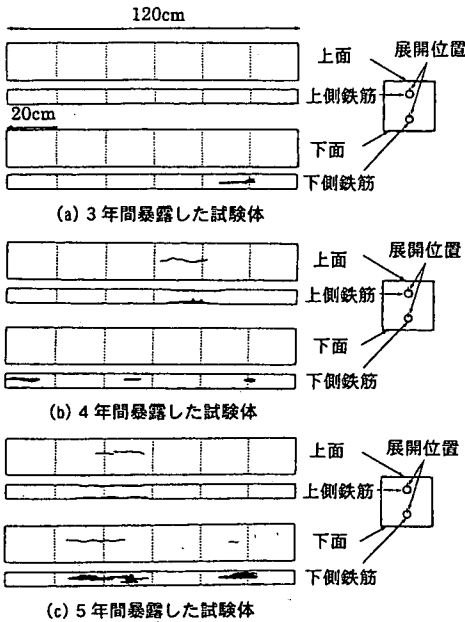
暴露試験体のひび割れおよび腐食状況
